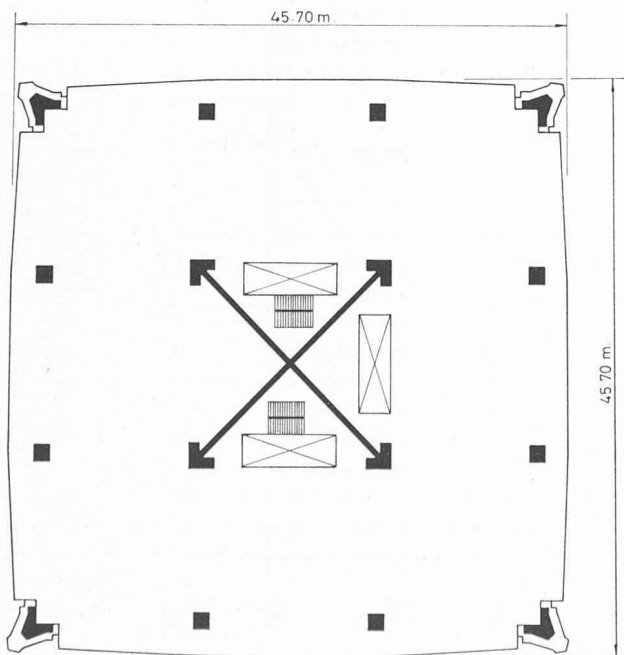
Tour place Victoria, Montréal 1967. Vue en plan. Structure avec parois croisées.
